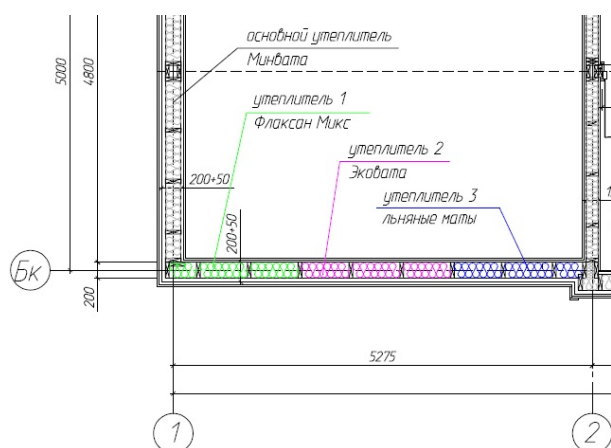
Размещение зон с дополнительными видами теплоизоляционных материалов в каркасной стене.
